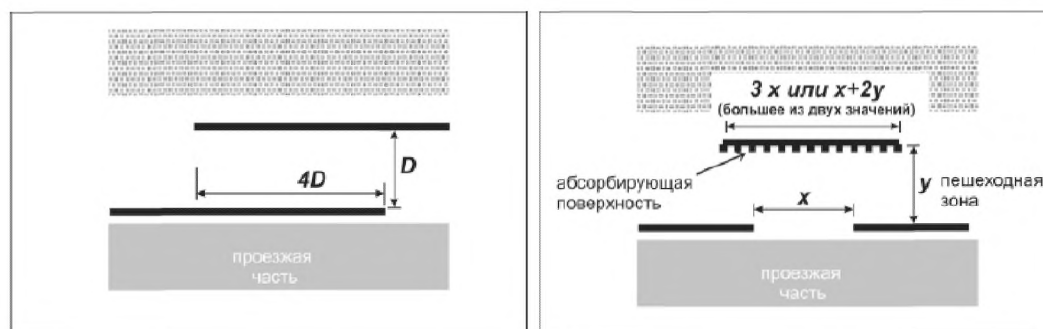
Схемы устройства экранов на участках разрыва и перекрытия
